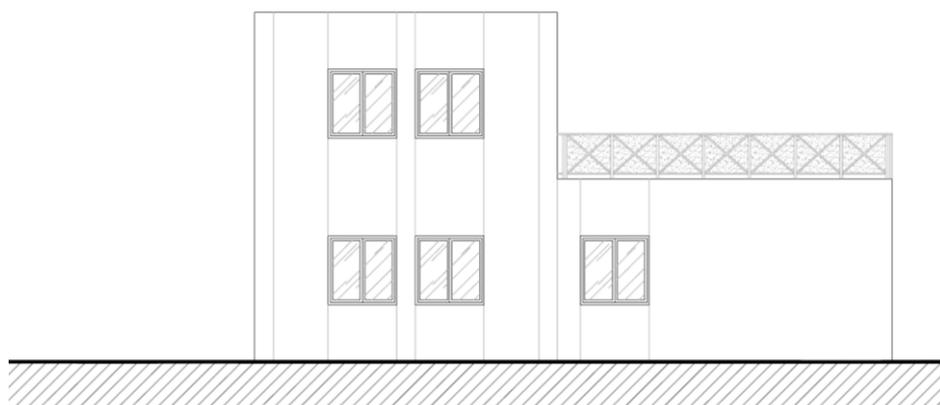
“Piccola palazzina per uffici. Prospetto Ovest”
